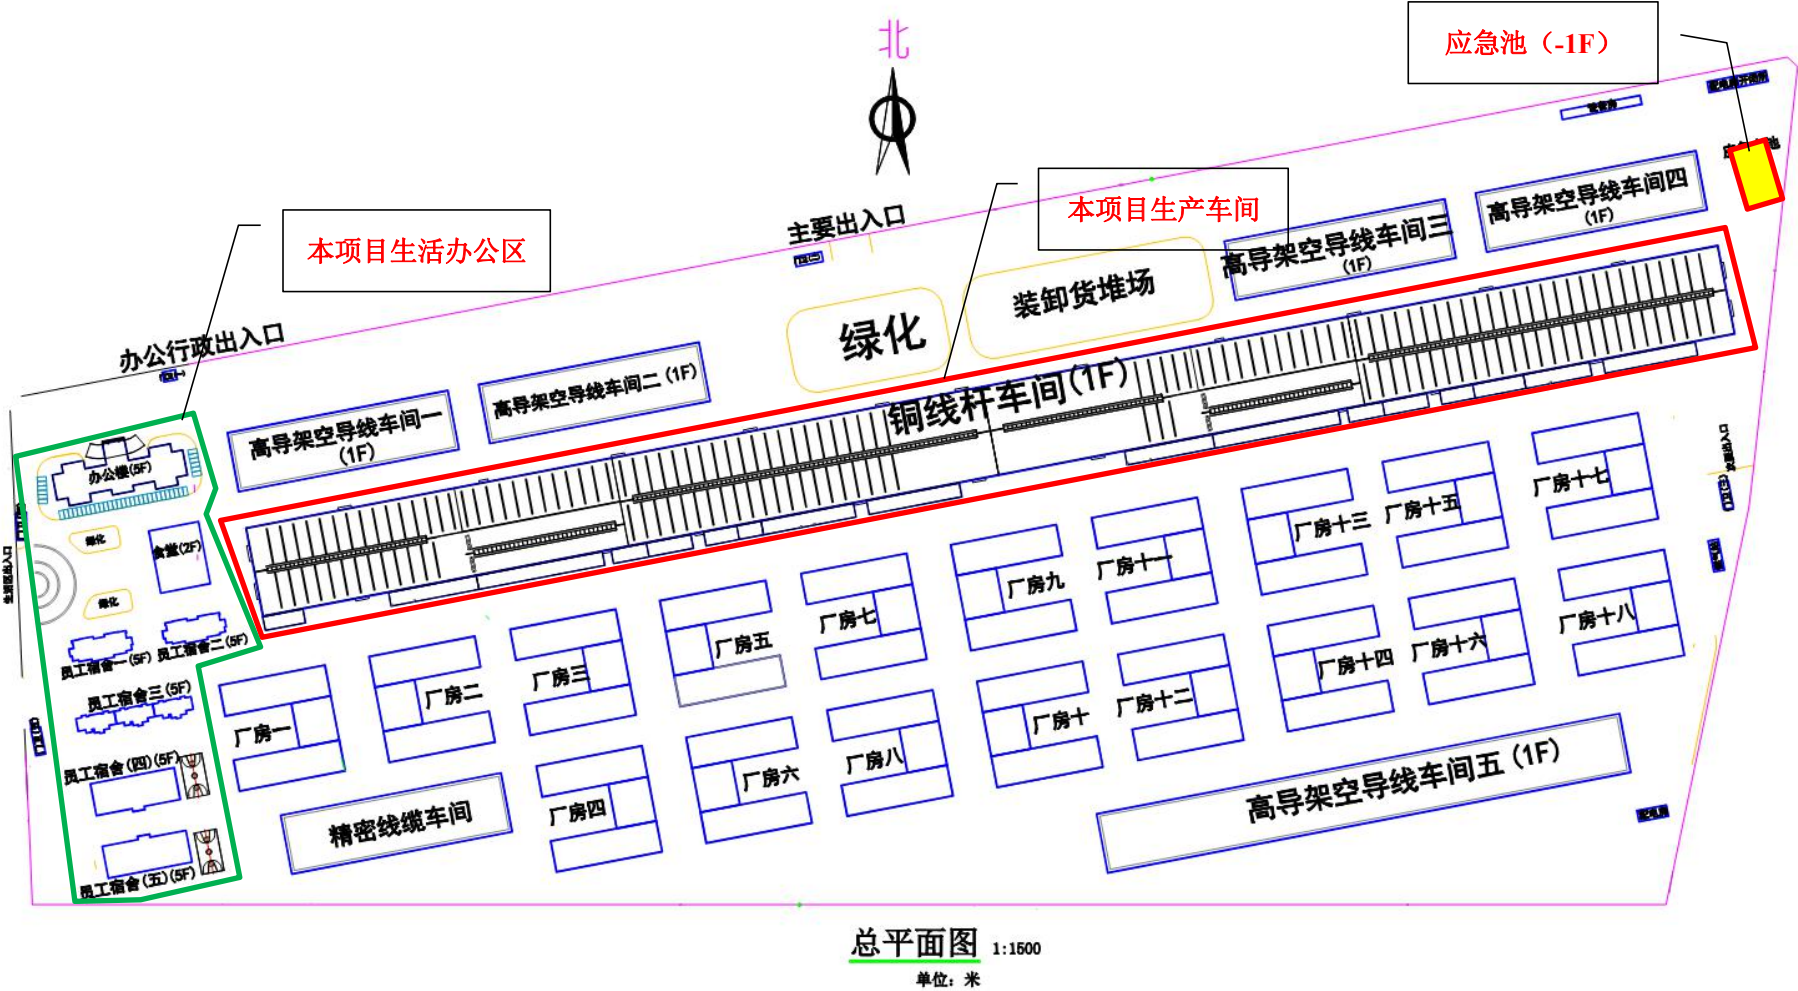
正威（惠州）新材料制造产业园项目总平面布置图
